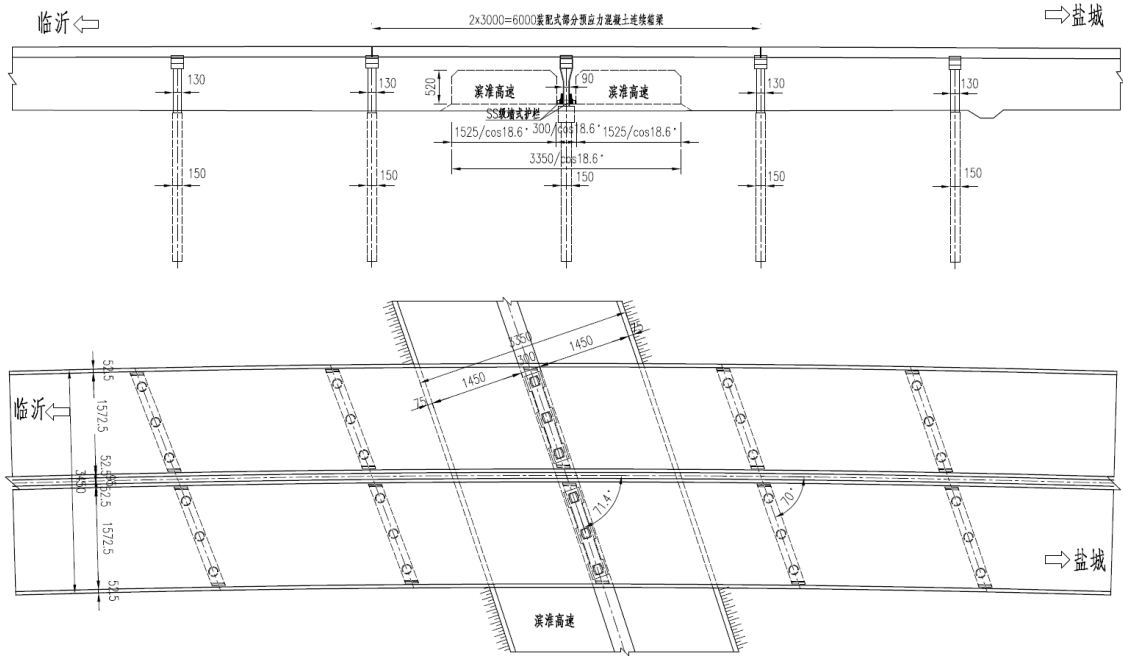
大套枢纽主线桥桥型布置图 (尺寸单位: cm)
